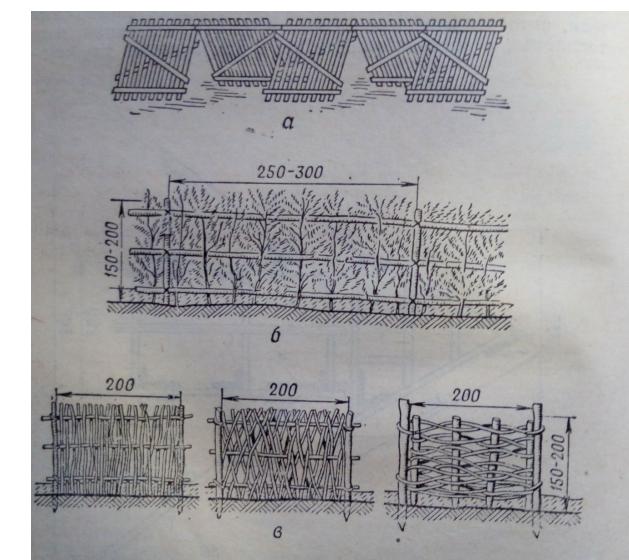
Снегозадерживающие заборы: а—из дощатых щитов; б и в— хворостяные на изготовление и установку 10 щитов требуется: 12—15 чел.-час., лесо-
